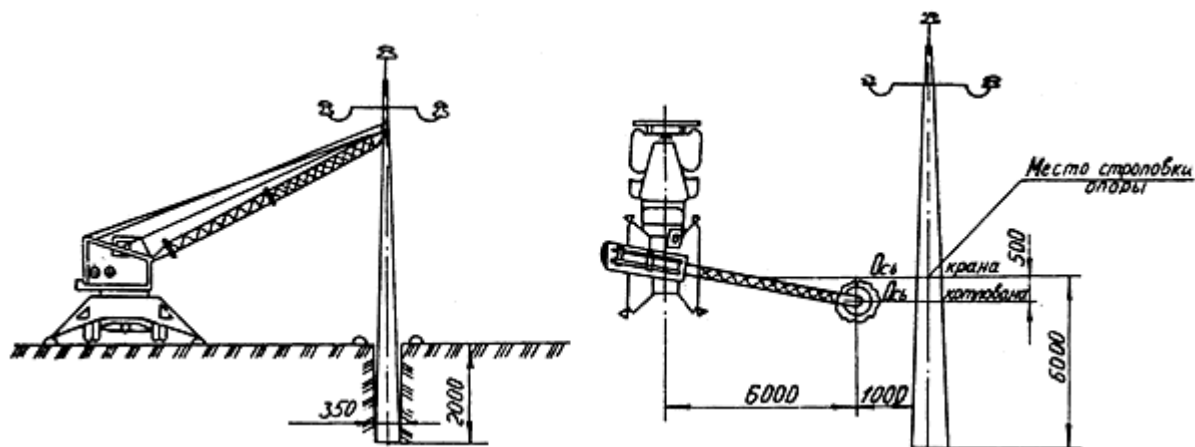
Демонтаж опор ВЛ 6-10 кВ с помощью автомобильного крана
